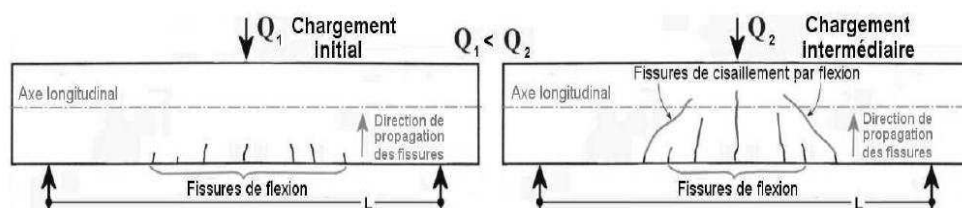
Représentation de la fissuration initiale et intermédiaire par moment fléchissant d'une poutre en béton armé [CROSTON\_06]
